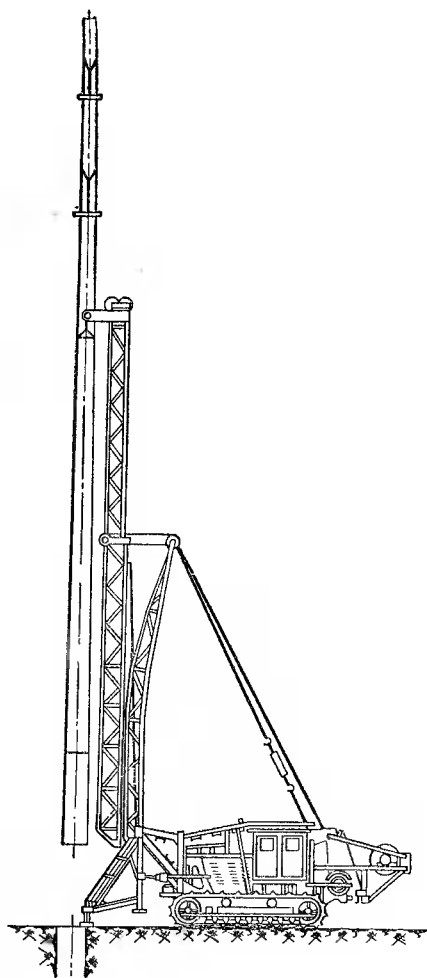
Подъем железобетонной опоры краном КЛЭП-7.
